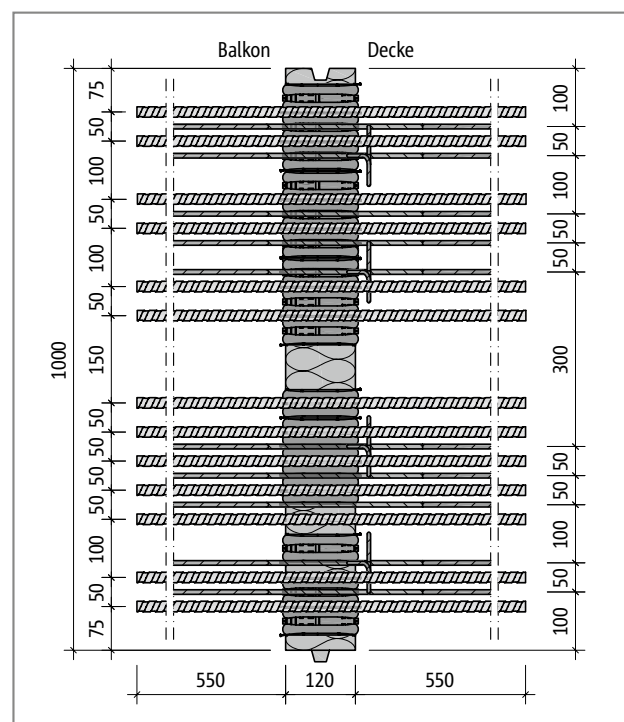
Schöck Isokorb® CXT Typ K-M10-V2: Produktgrundriss
